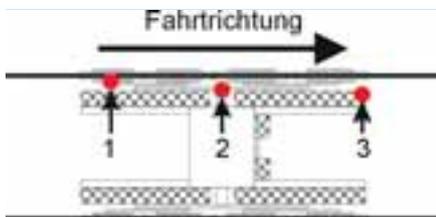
Grundriss eines Stützenkopfes / Positionierung der Messaufnehmer
